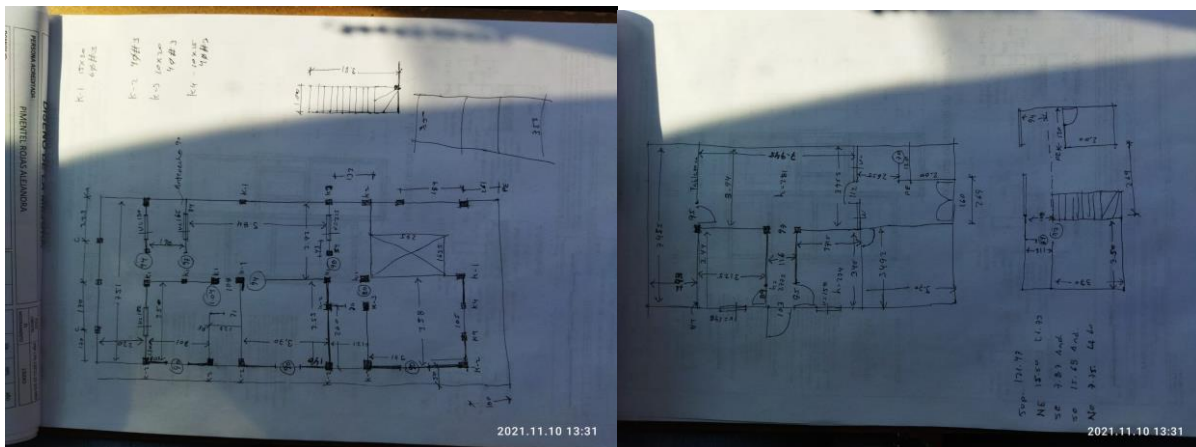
Levantamiento de proyecto de vivienda en alcaldía Tlalpán
